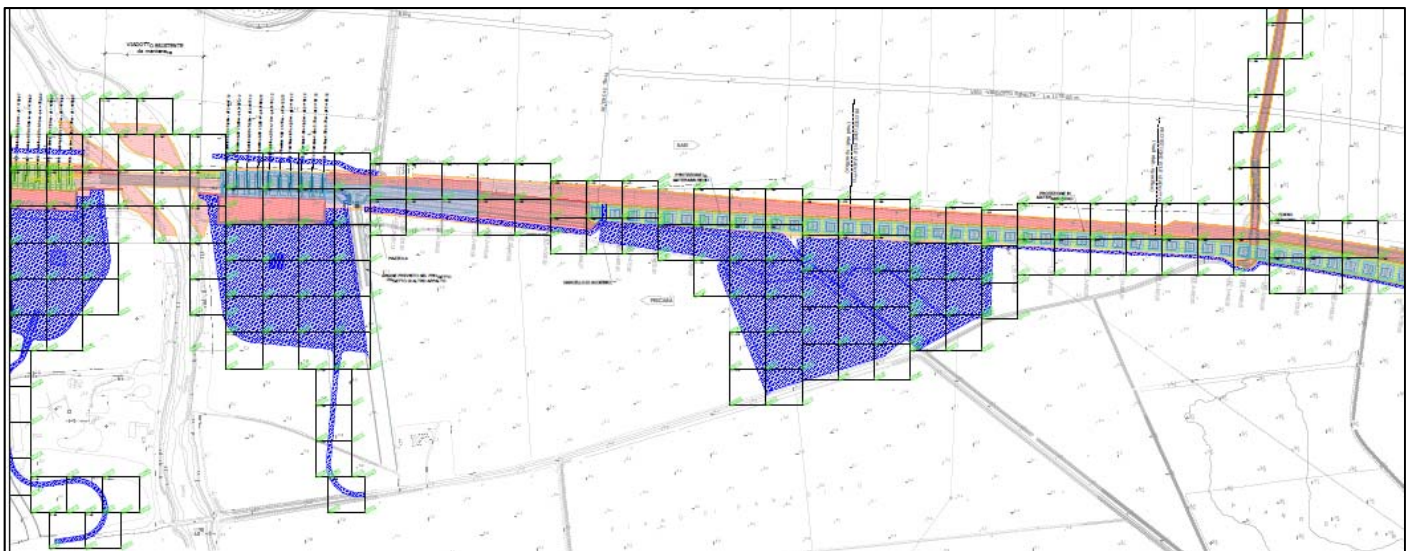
Stralcio Planimetrico tav2/4 delle aree da assoggettare a B.O.E
